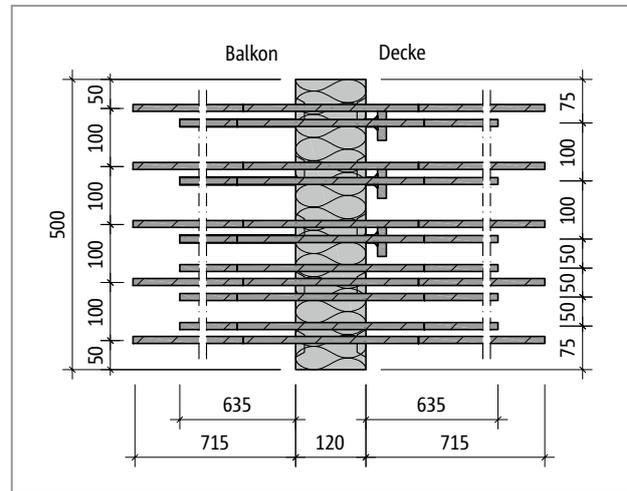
Schöck Isokorb® XT Typ C-R-M2-V2: Produktgrundriss
